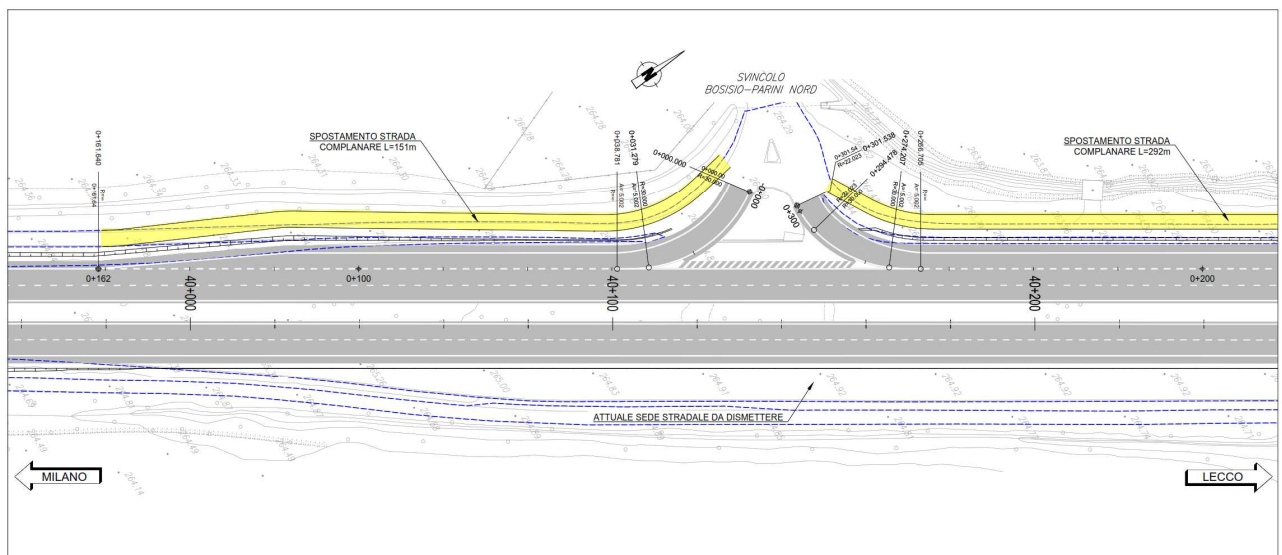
Stralcio planimetrico soluzione progettuale dello svincolo Bosio Parini Nord
